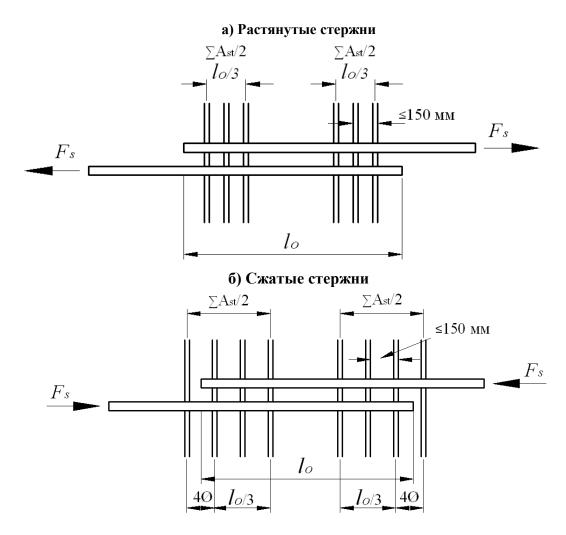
Поперечная арматура в зоне нахлеста для растянутых (a) и сжатых (б) стержней
